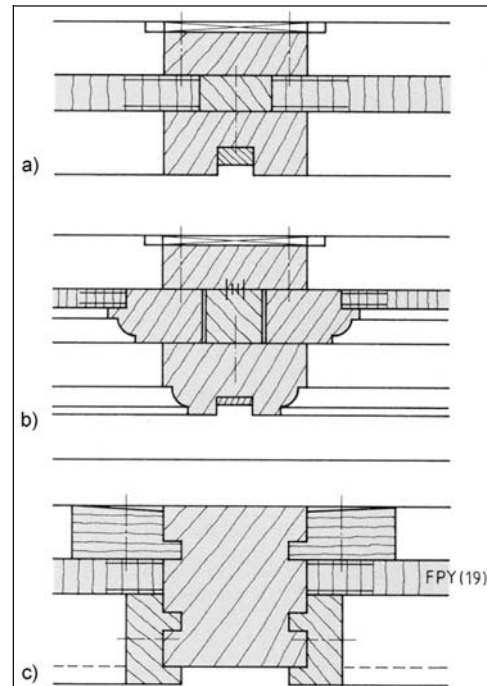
Plattendecke, Decken/Wand-Anschluss
